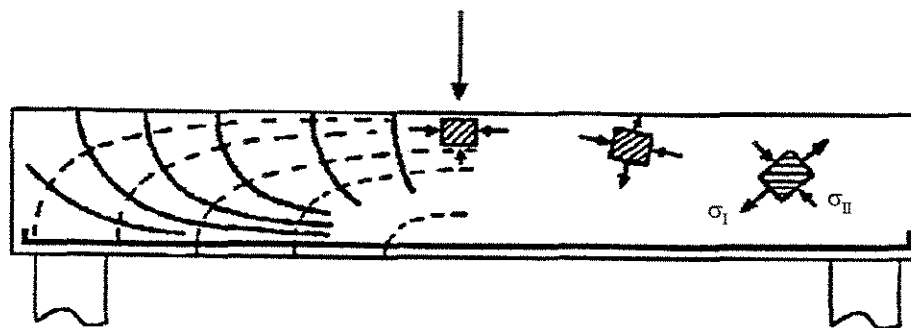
Trajetória das tensões principais numa viga de concreto armado não fissurada
